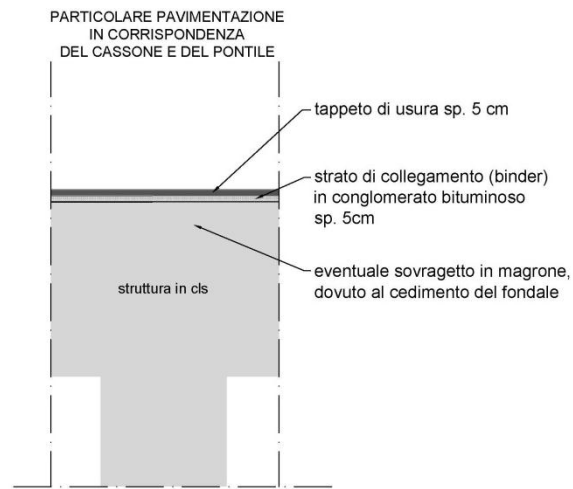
Pavimentazione - sezione tipo in corrispondenza del cassone
